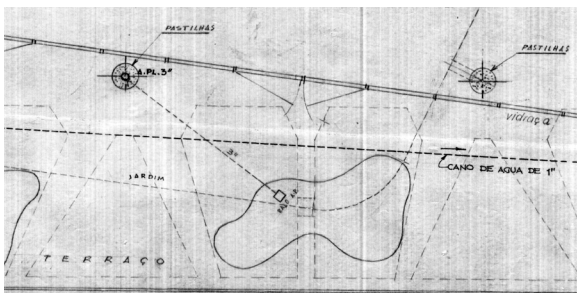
Ampliação do detalhe do pilar com tubulação de águas pluviais embutida
